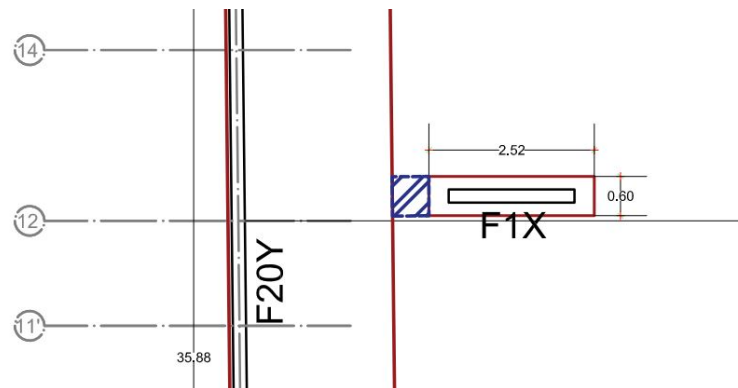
Esquema de la conexión de una zapata aislada al muro perimetral, mediante cadena.
